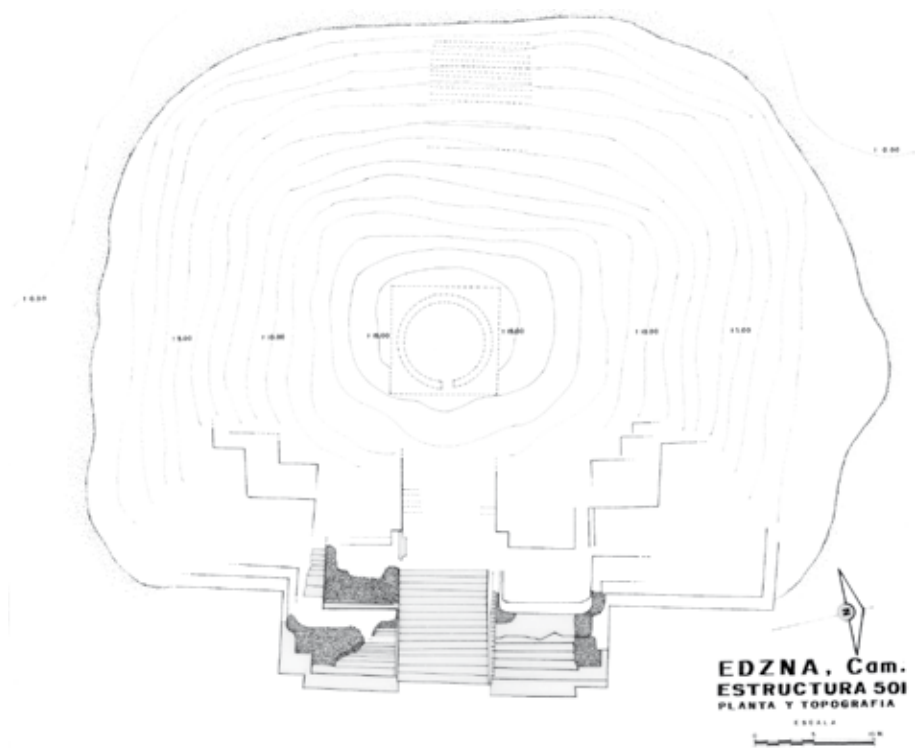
Planta de la Estructura 501 indicando los sectores excavados y consolidados.
